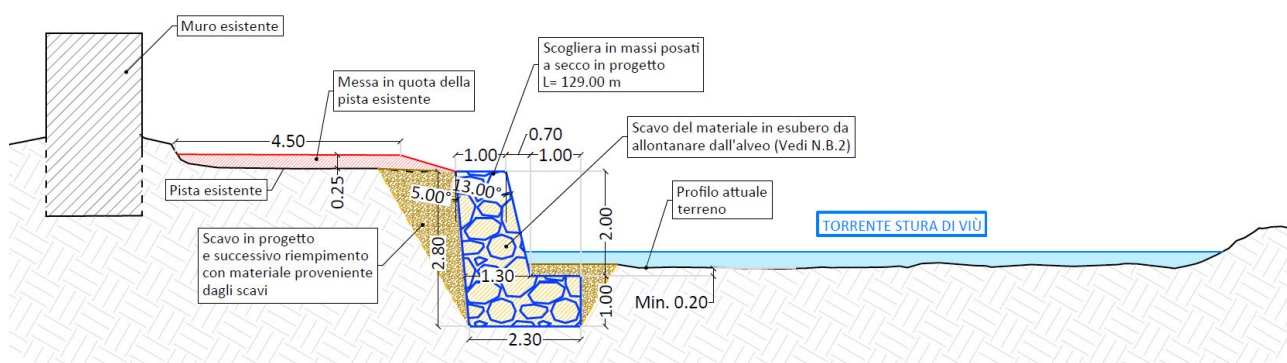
Estratto della tavola 06 - Sezioni di progetto
